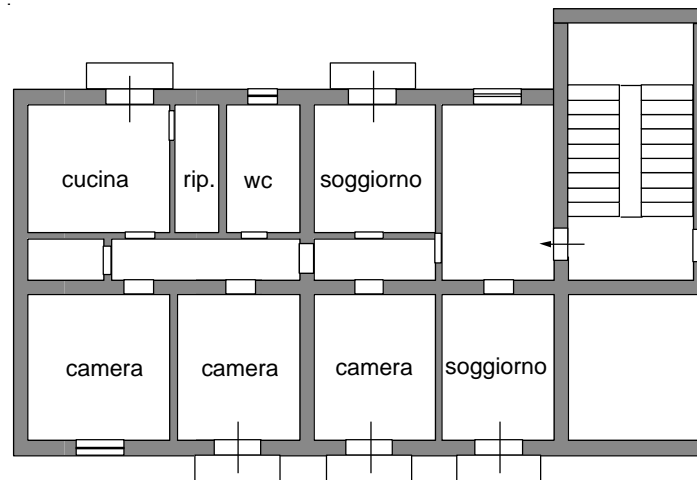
Planimetria dell'appartamento tipo degli Edifici Antichi a Palermo
